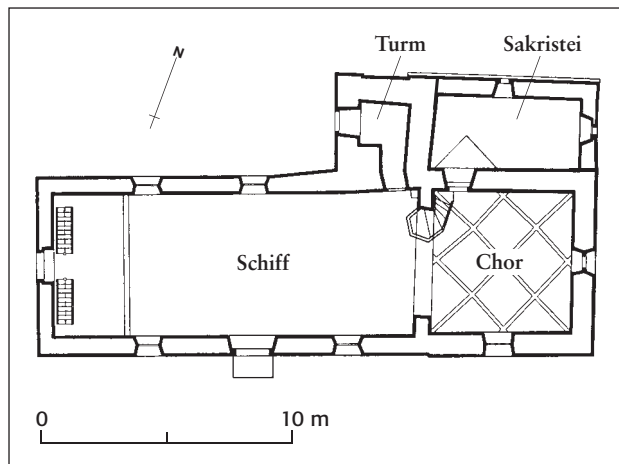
Castrisch, evangelische Kirche. Grundriss. Mst. 1:300.
